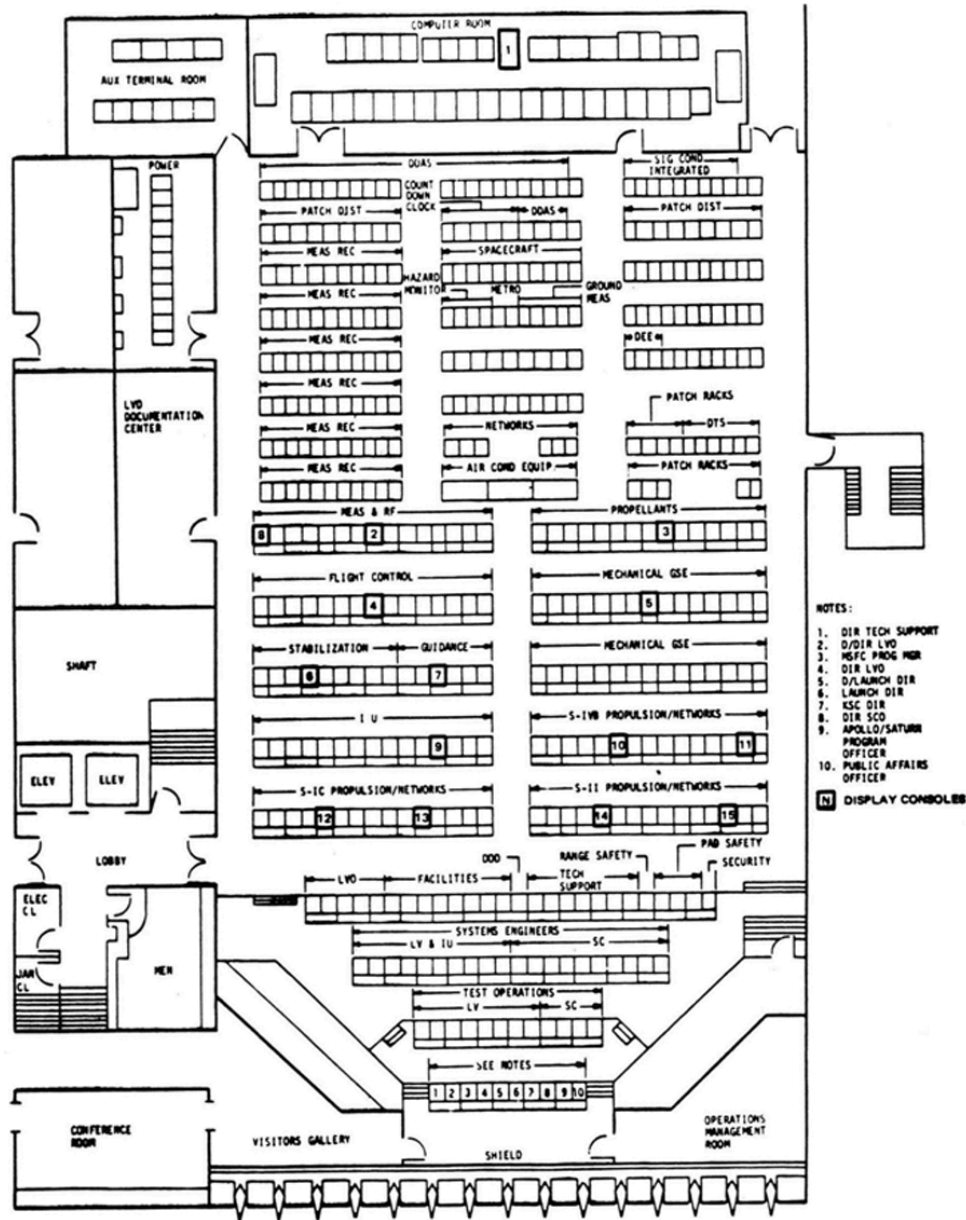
Cross-section* dari Pusat Kontrol Peluncuran yang mengilustrasikan bagaimana ruang-ruang firing menyatu dengan denah bangunan secara keseluruhan
